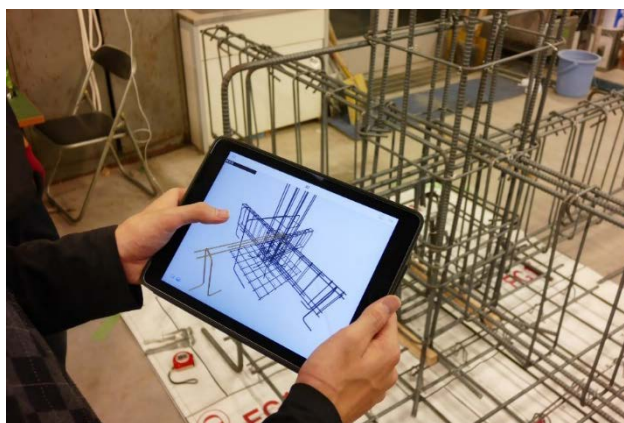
拡張 3D 教材群を使用した鉄筋組立施工
